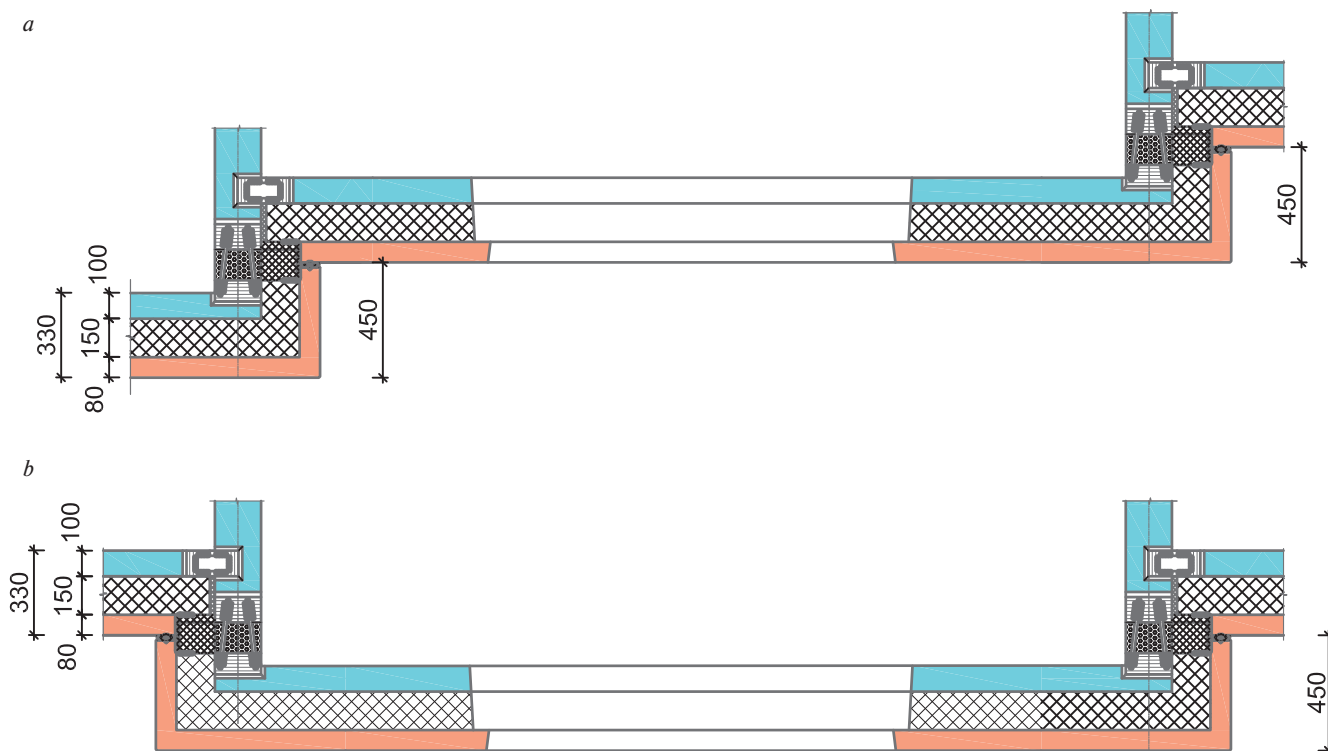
Варианты ступенчатых фасадов: а – Г-образная ступенчатая наружная панель; б – П-образная ступенчатая наружная панель
